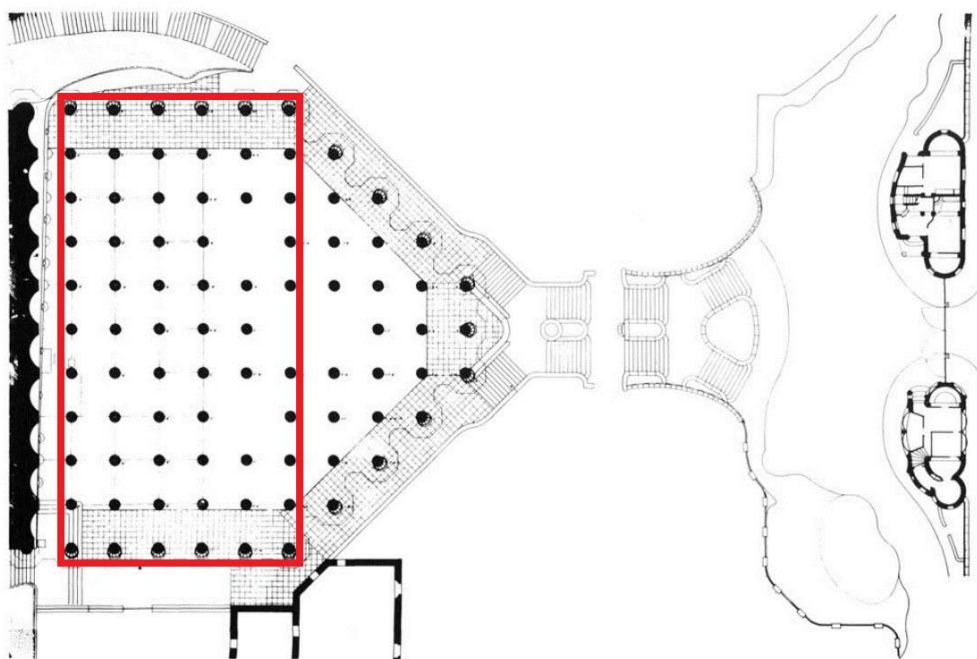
Detalle de las columnas de la Sala Hipóstila del Park Güell
